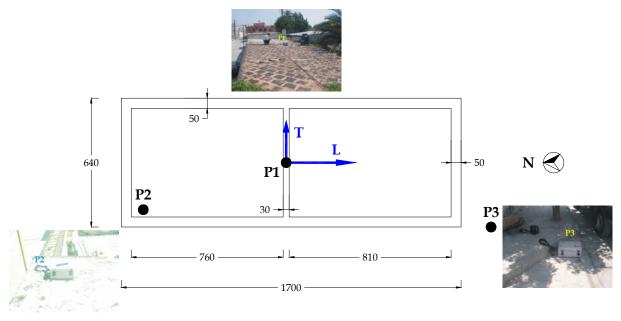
Croquis en planta (dimensiones en centímetros) de la azotea de la vivienda 3 y ubicación de los puntos de registro de vibración ambiental.
